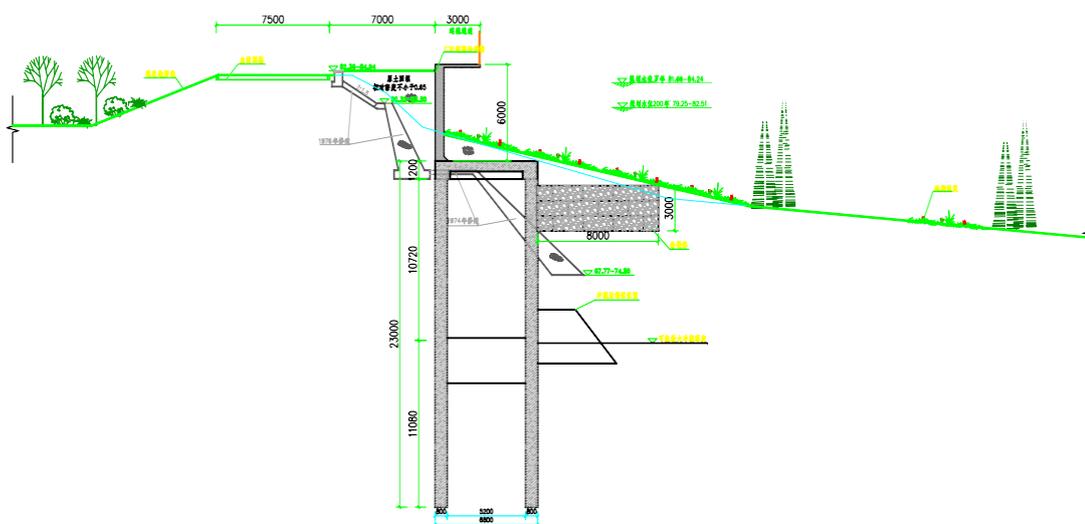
双排钢筋混凝土防冲墙加固方案（典型横断面）
